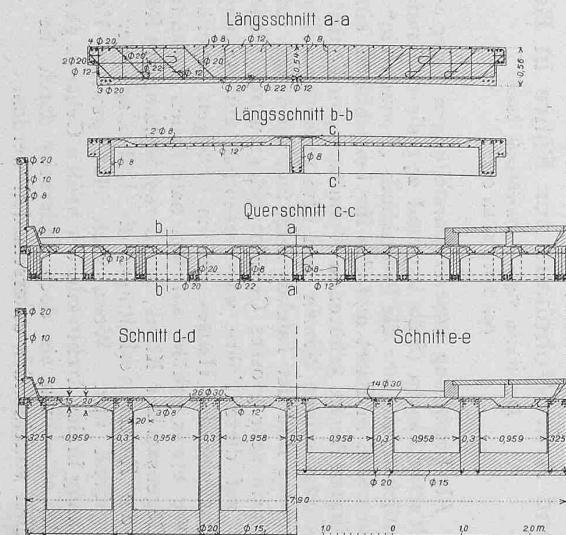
(links). Schnitte zu Kragträger und Plattenbalken. — 1 : 100.
